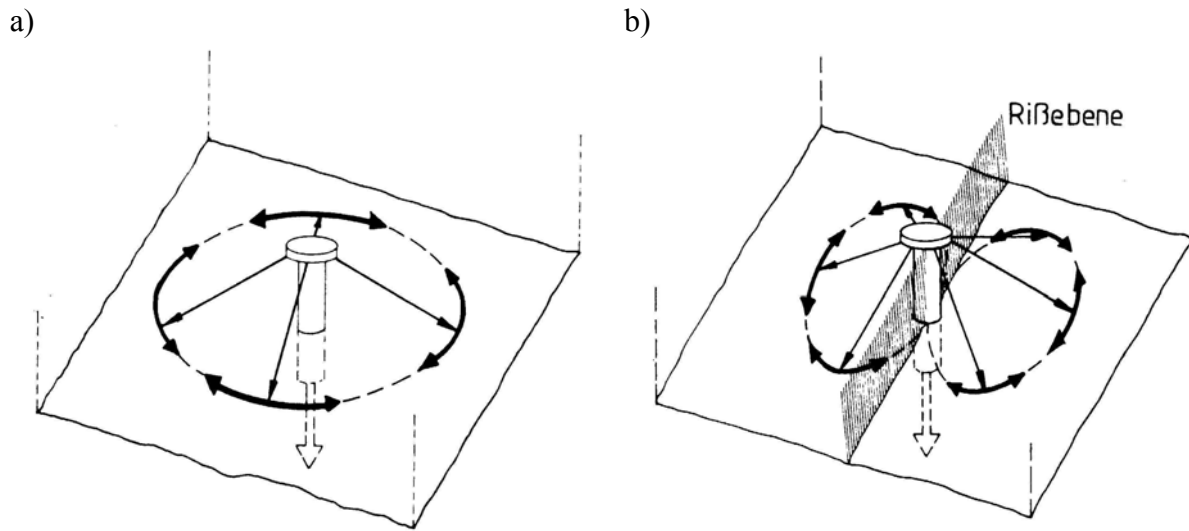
Einfluss von Rissen auf den Kräfteverlauf im Bereich eines Kopfbolzens unter zentrischer Zugbeanspruchung nach Rehm, Eligehausen, Mallée (1988): a) ungerissener Beton, b) gerissener Beton
